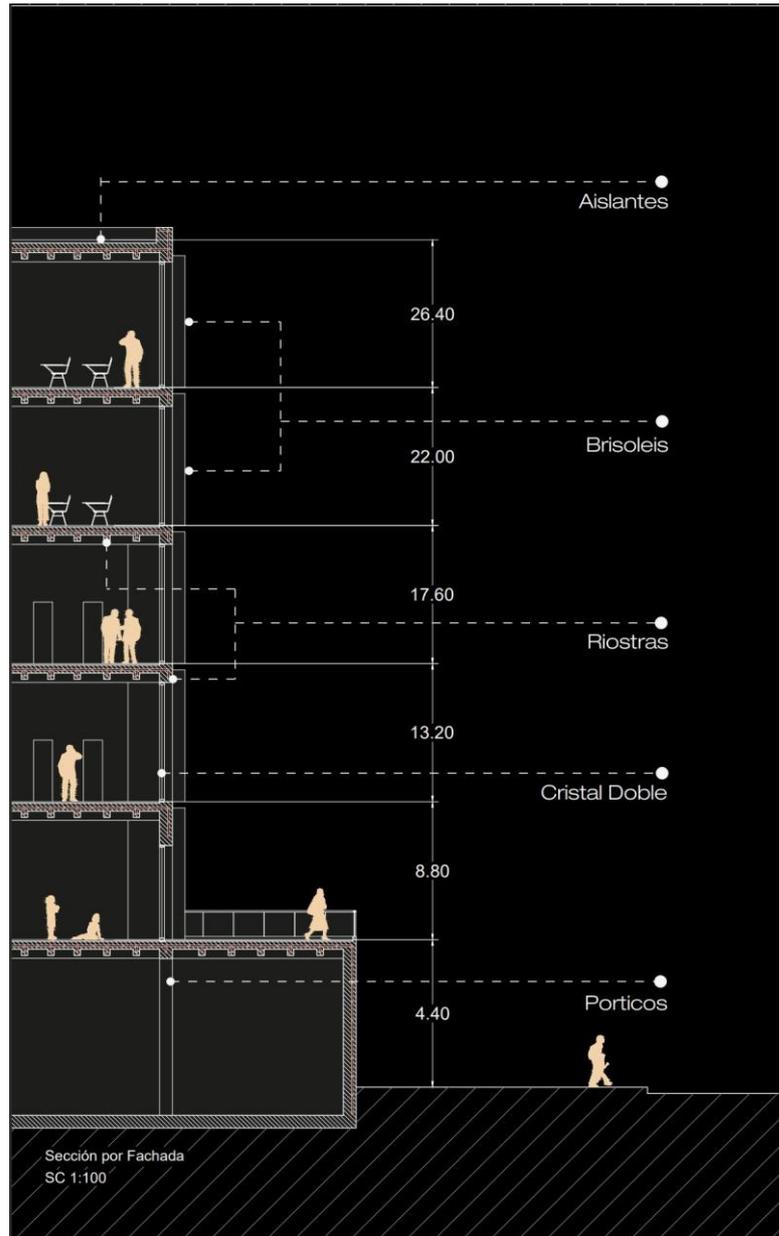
Est. Corte por Fachada. Elaboración Propia
